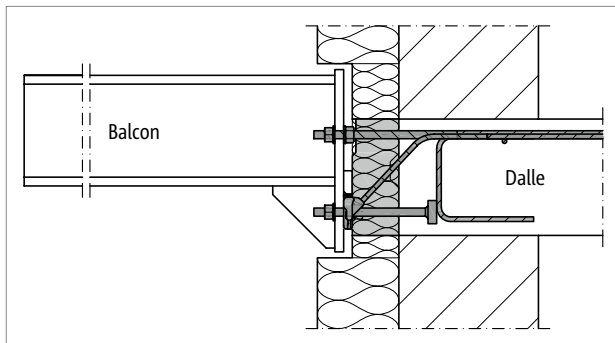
Schöck Isokorb® T type SK : Transition sans obstacle grâce au décalage en hauteur
